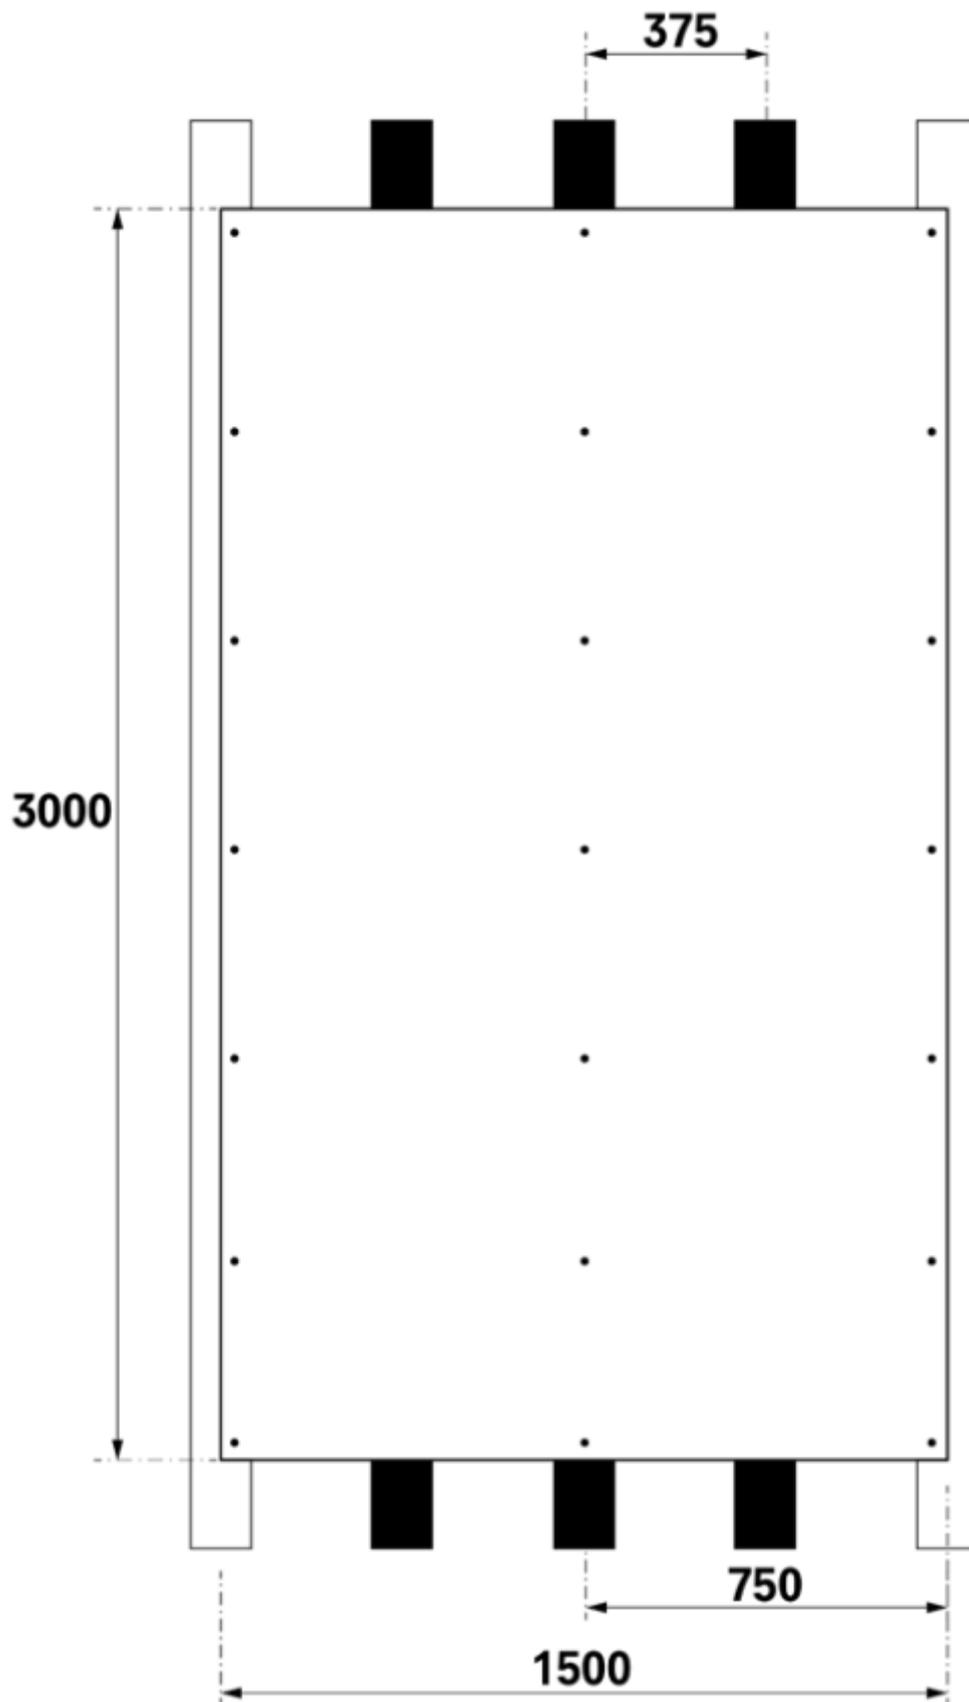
Pose Q4 suivant rapport d'essai DEB 21-08579
